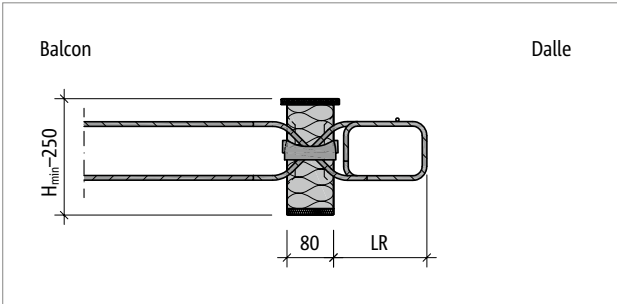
Schöck Isokorb® T Type Q-E-W-VV : Coupe du produit, affichage de la longueur d’installation LR
